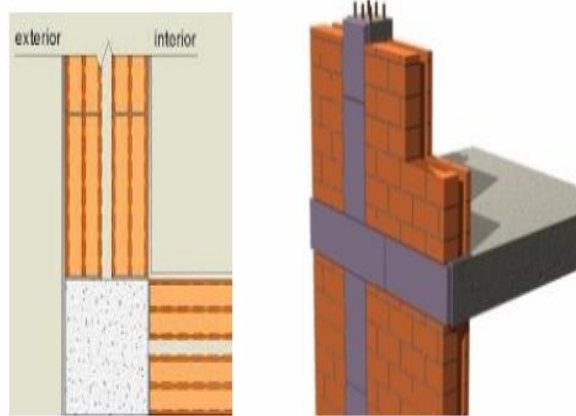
Exemplos de zonas de ligação da envolvente (Abreu 2020)
